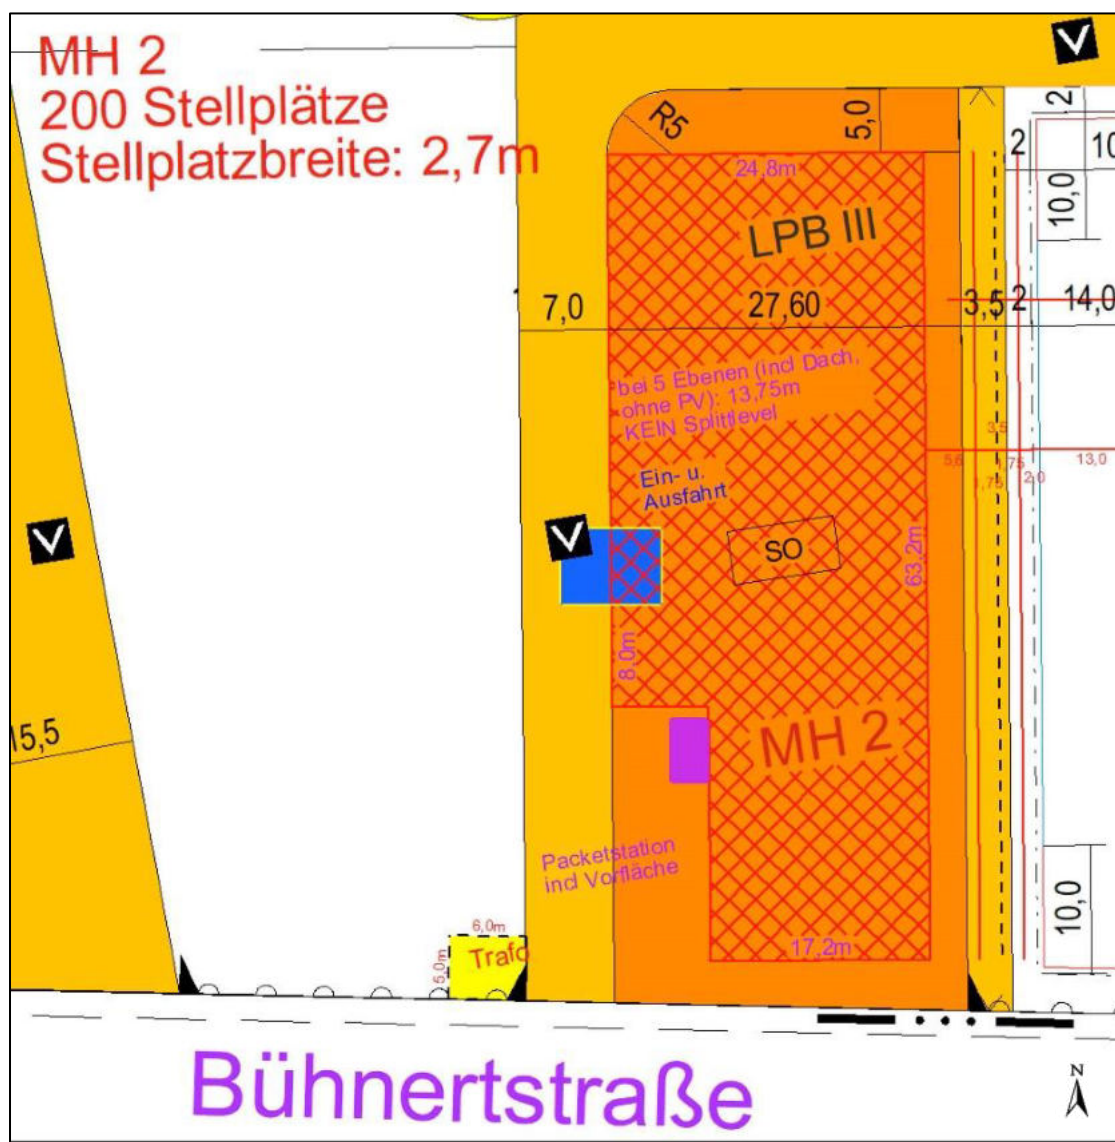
Lageplan zu MH 2 "Bühnertstraße" /11/
